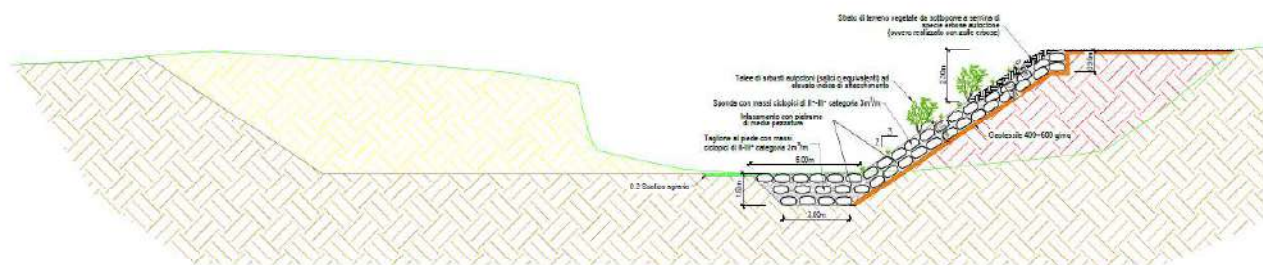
Sezione tipologica di progetto prevista nell'area di intervento (retino rosso in planimetria)
